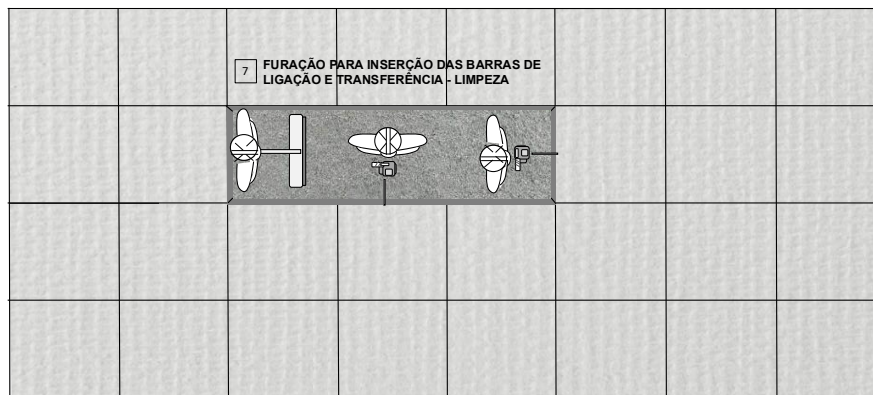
Furação lateral no concreto existente para inserção das barras de ligação/transferência e limpeza criteriosa das perfurações.
